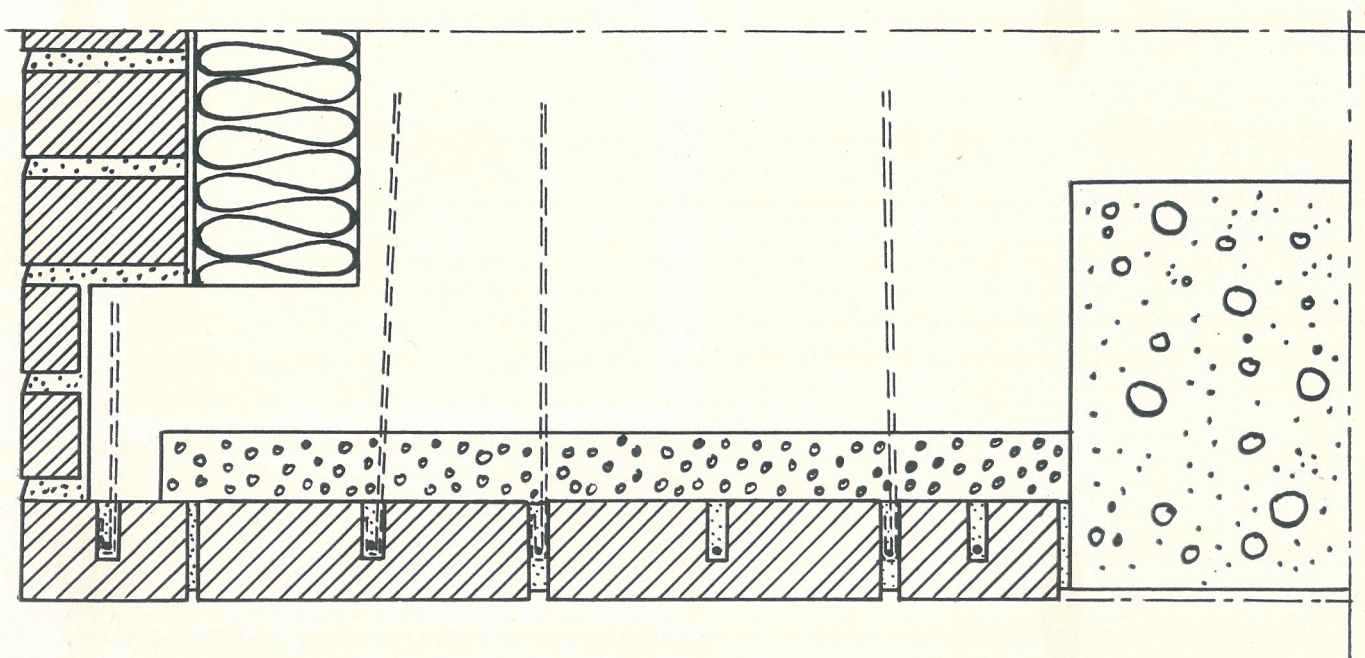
Snitt genom bjälklag med underliggande tegelbeklädning. Tegelementen lades i botten av formen och ovanpå lades en värmeisolering av cementbunden leca. Ovanpå detta göts sedan betongbjälklaget.
